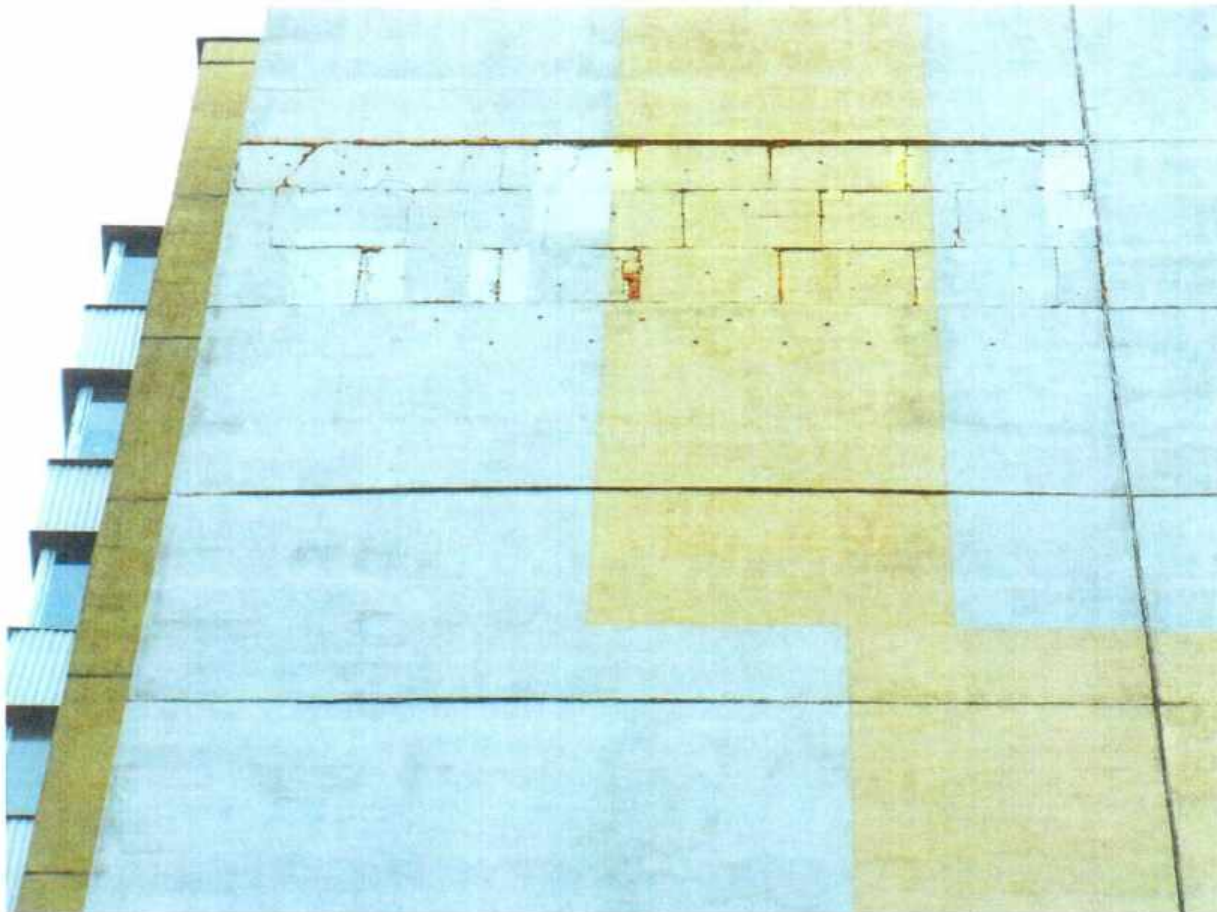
Фрагмент торцевого фасада по оси «2» в уровне 14-го этажа
